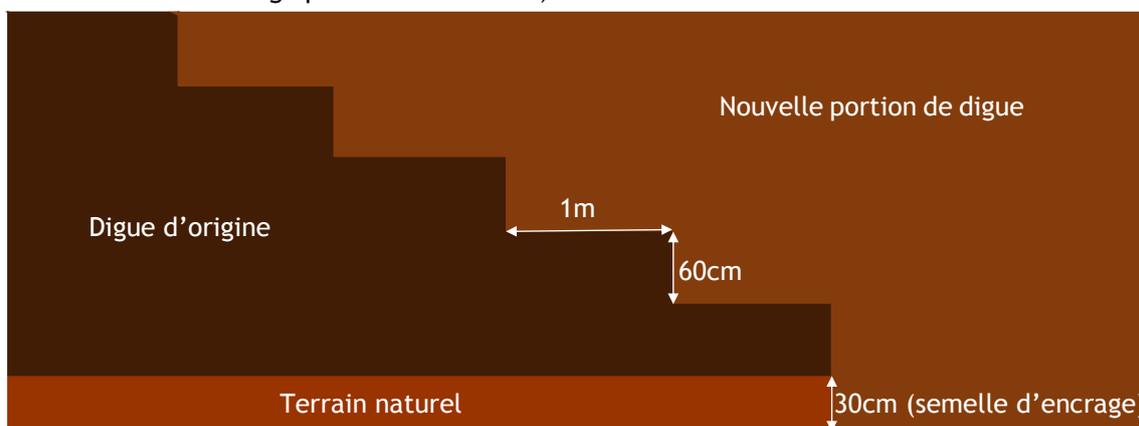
Schéma en coupe longitudinale au droit du raccordement
